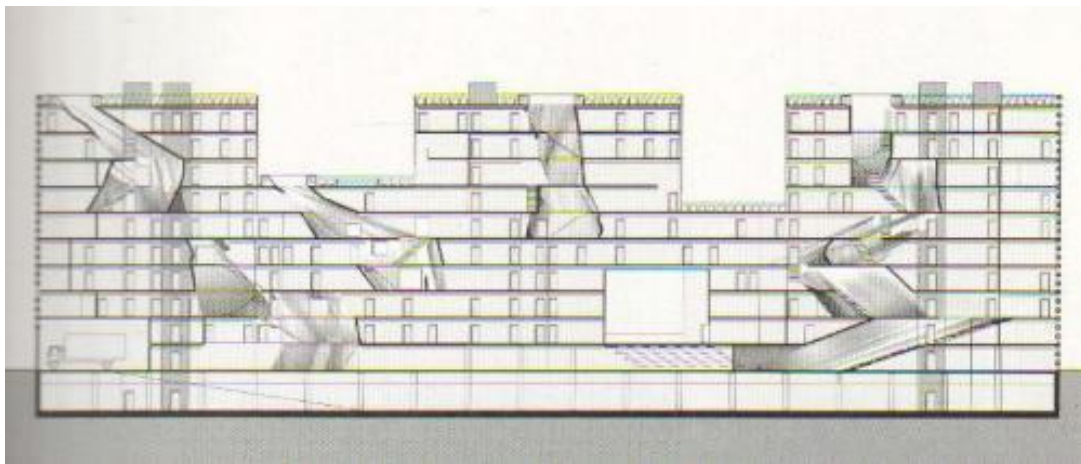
Corte. Simmons Hall - MIT, Fuente: Steven Holl architects
